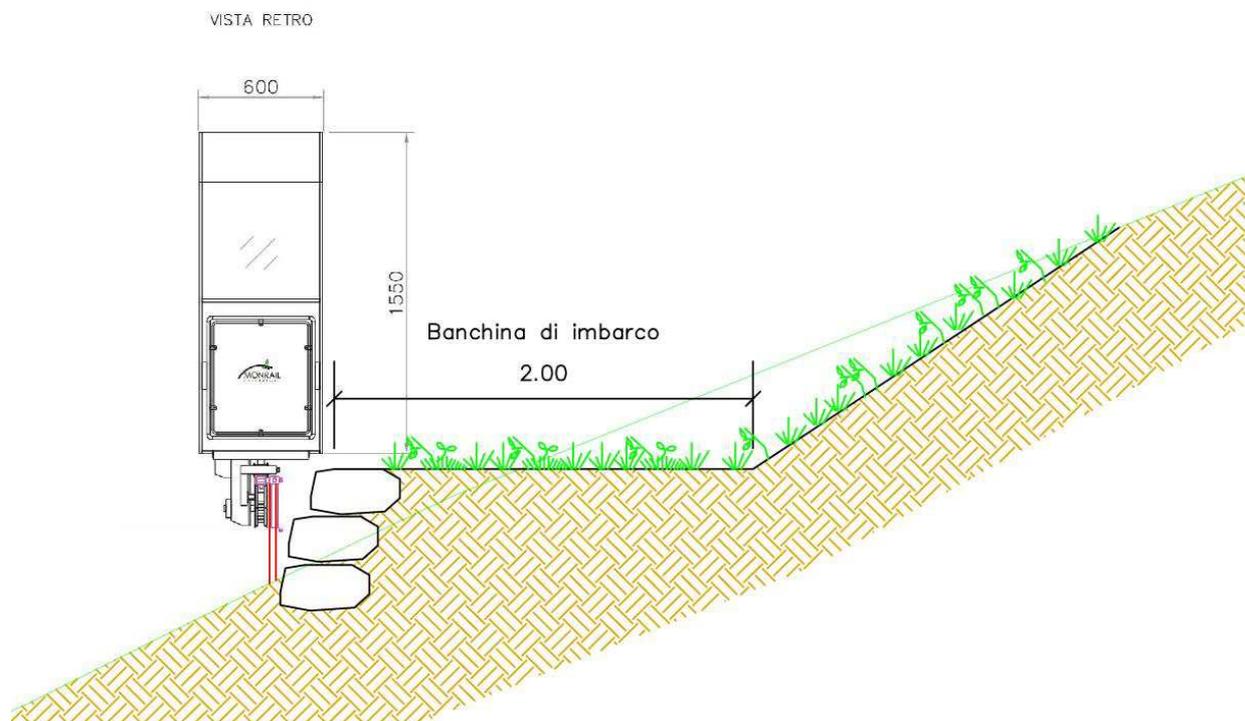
Sezione tipo del convoglio nella zona da adibire a banchina
